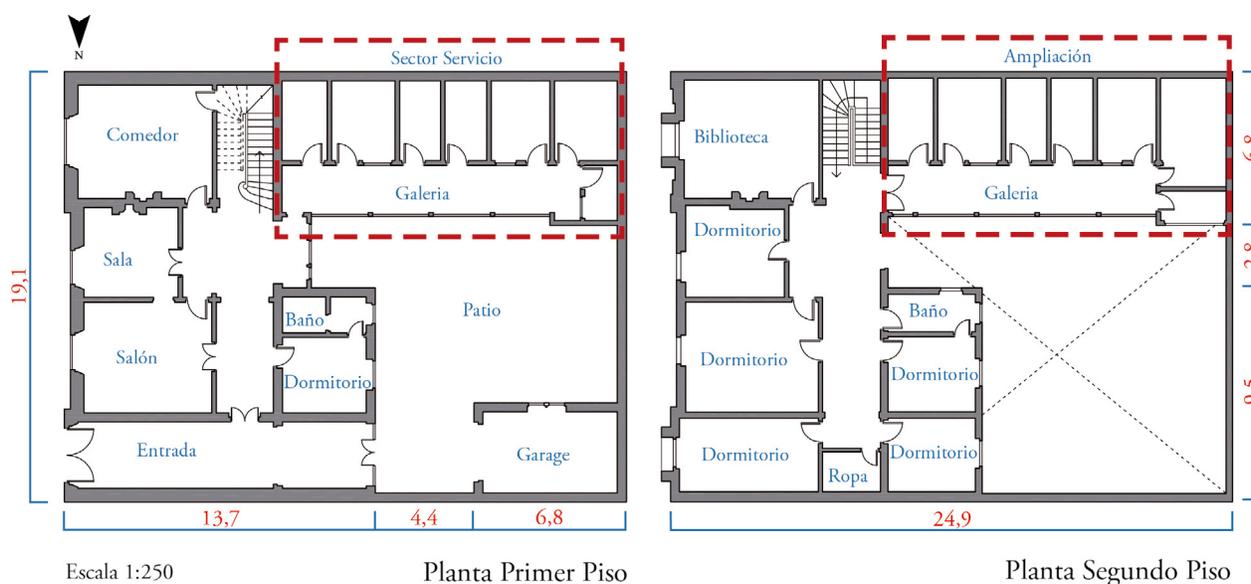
Plantas primer y segundo piso Casa Tapia | Fuente: Elaboración propia (2021), en base a terreno y planos de alcantarillado
